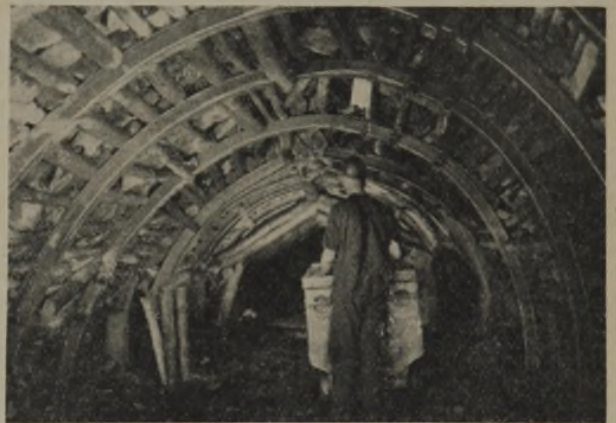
Zeche Recklinghausen, Flöz A, 4. Sohle, Grundstrecke Westen. Übergang vom Mollausbau zum Toussaint-Heintzmann-Spezialstreckenbogen Profil 21 kg/m, 1/2 Jahr nach dem Einbau.
